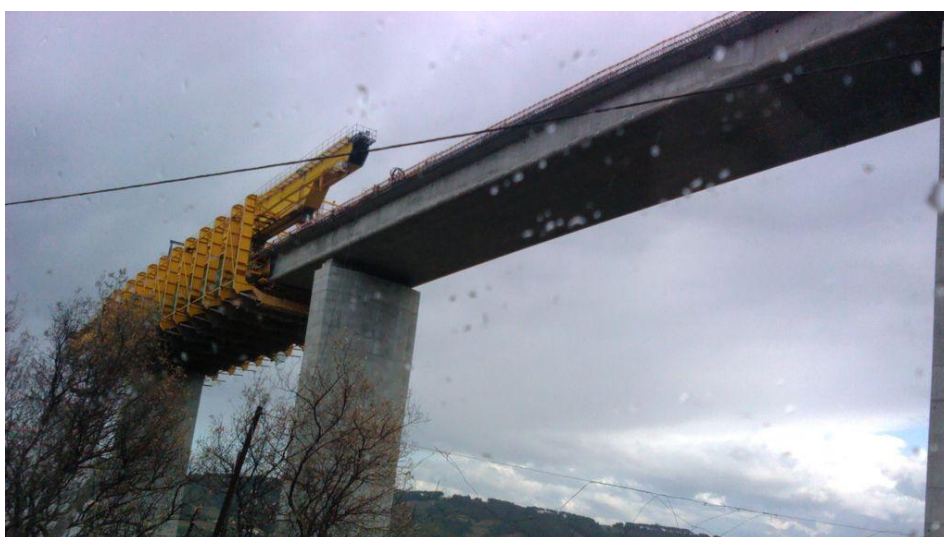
Tabuleiro do sub-viaduto Poente em construção (Melo, 2011)
